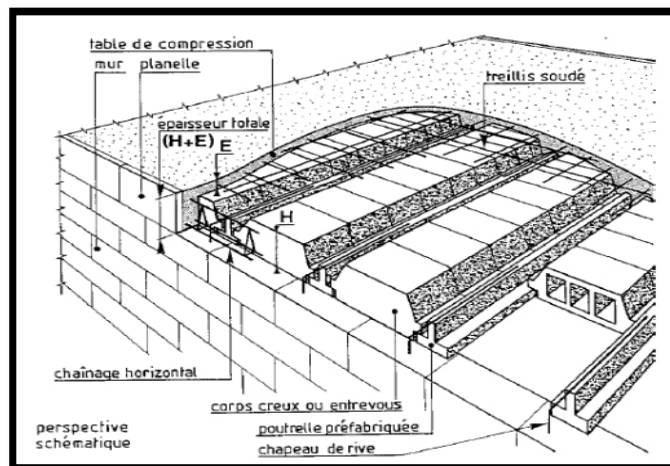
les éléments principaux d'un plancher à corps creux.³¹²
